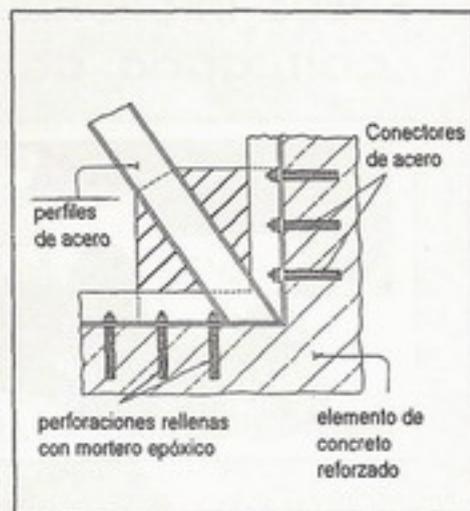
Conexión entre elementos de arrioste de acero y la estructura existente por medio de pernos y elementos colectores
